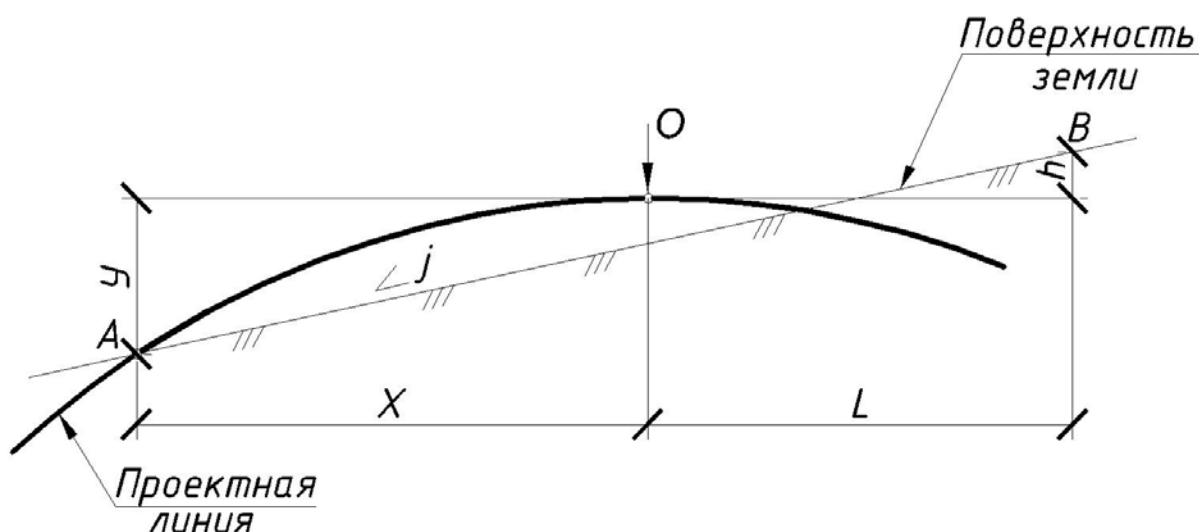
Схема определения точки перехода из насыпи в выемку на кривой
